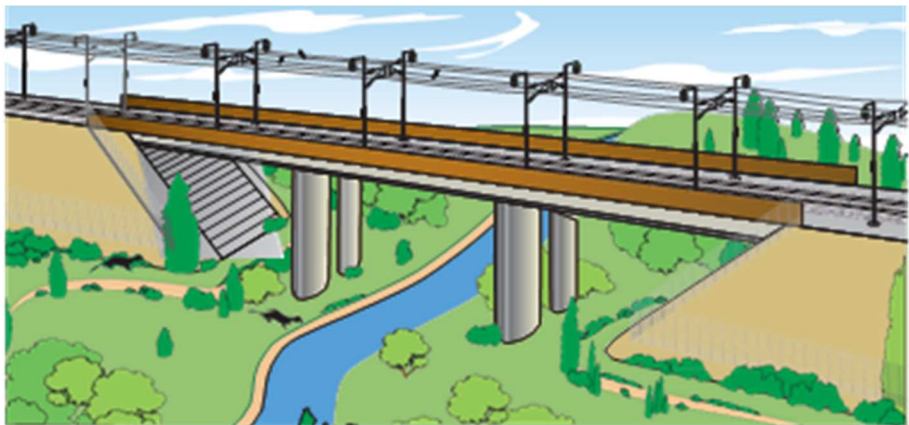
Ouvrages mixtes hydraulique: franchissement par pont type portique
